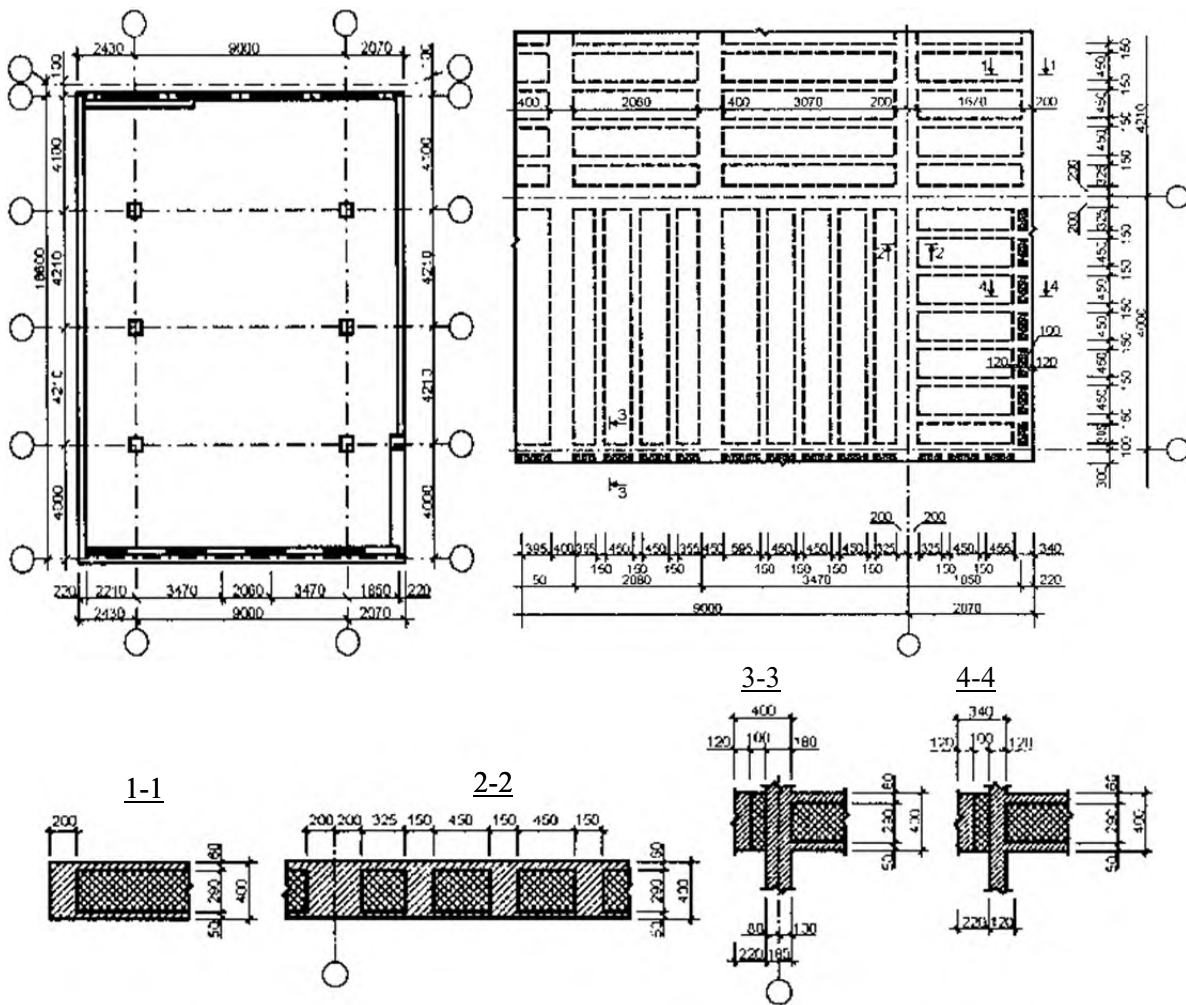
Каркасная система с плоским перекрытием коробчатого сечения
